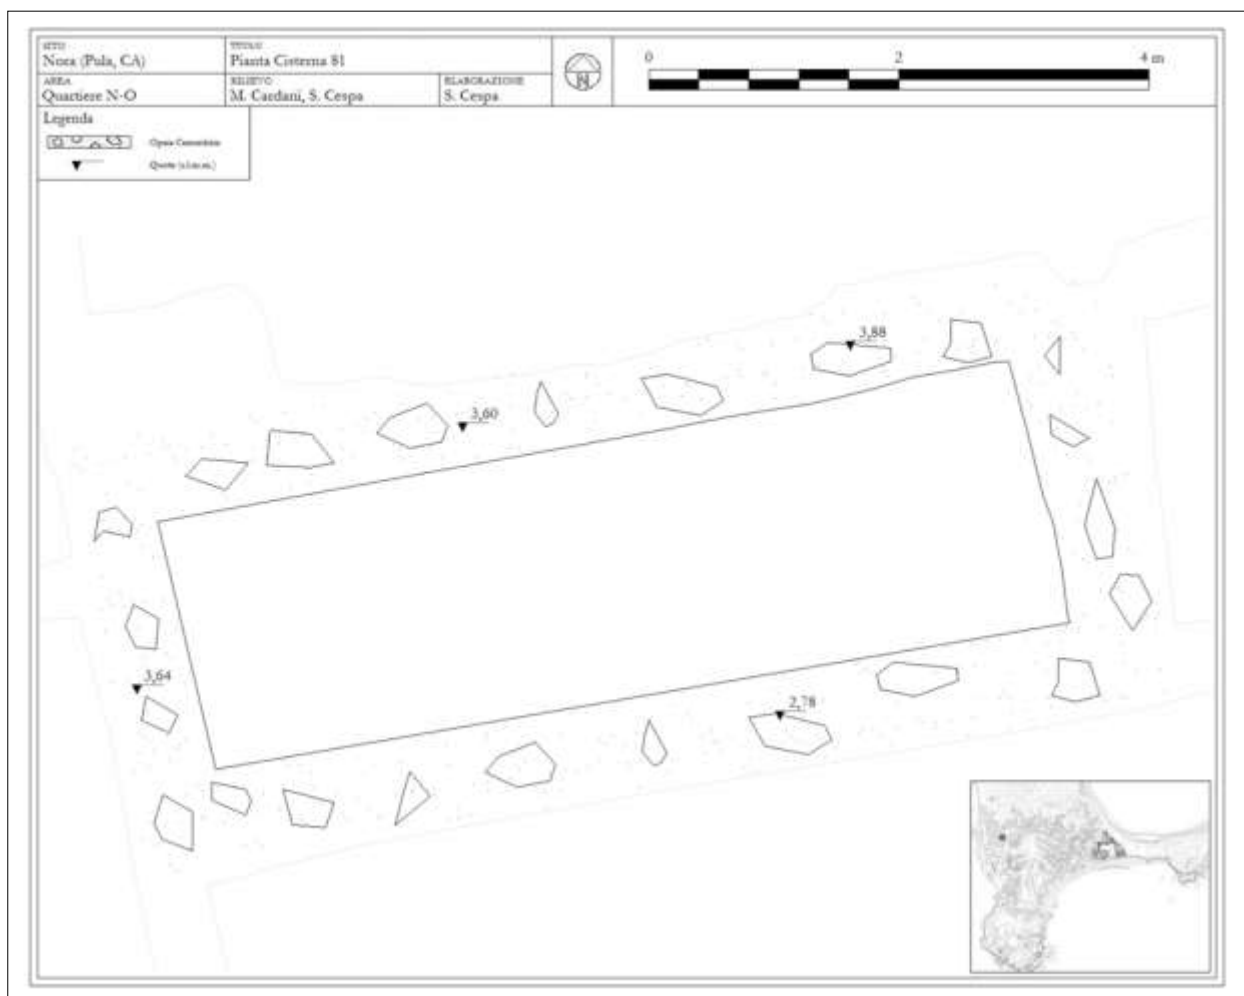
Pianta della presunta cisterna 81 (elaborazione dell'autore).
